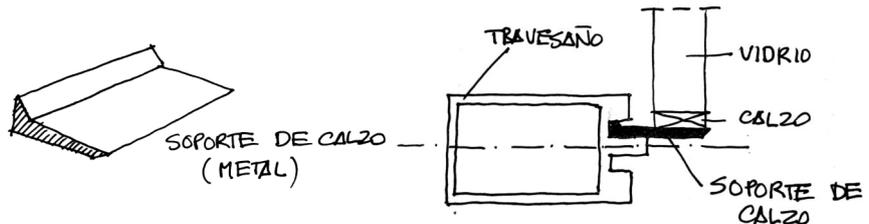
Izquierda: soporte metálico del vidrio; derecha: sección vertical de muro cortina Stick.
